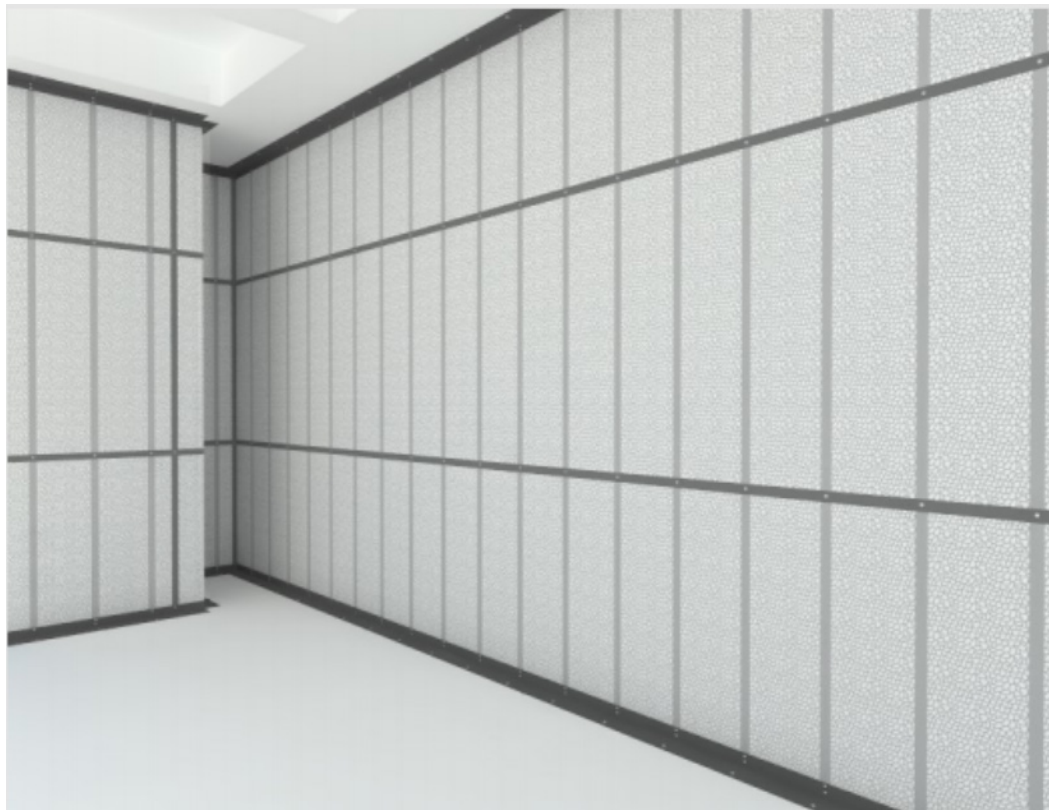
Vista interior de panel prefabricado de poliestireno aplicado en fachada. (Elaboración propia)
